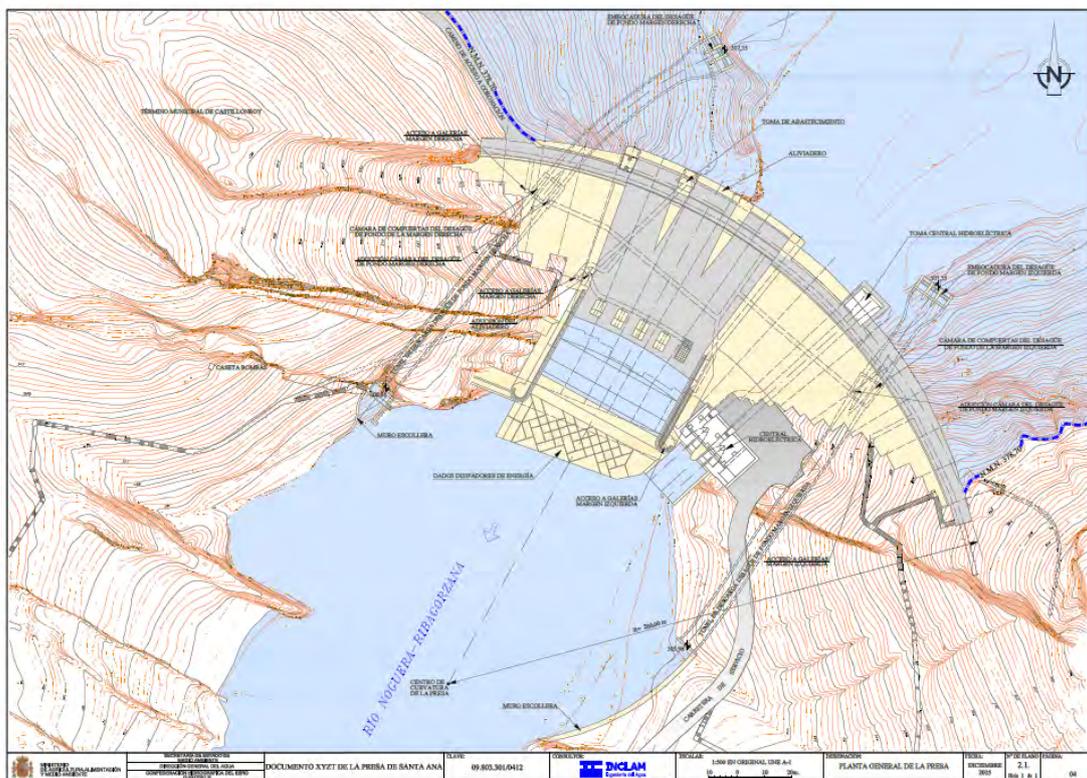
Planta general de la presa de Santa Ana. Fuente: (CHE)
